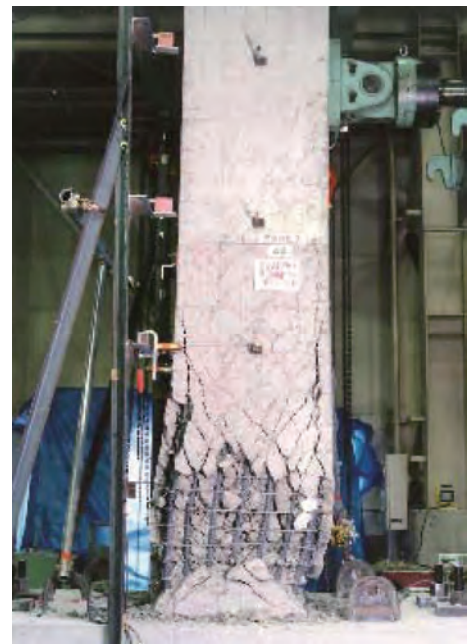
曲げ降伏後せん断破壊を生じたRC柱の破壊状況
